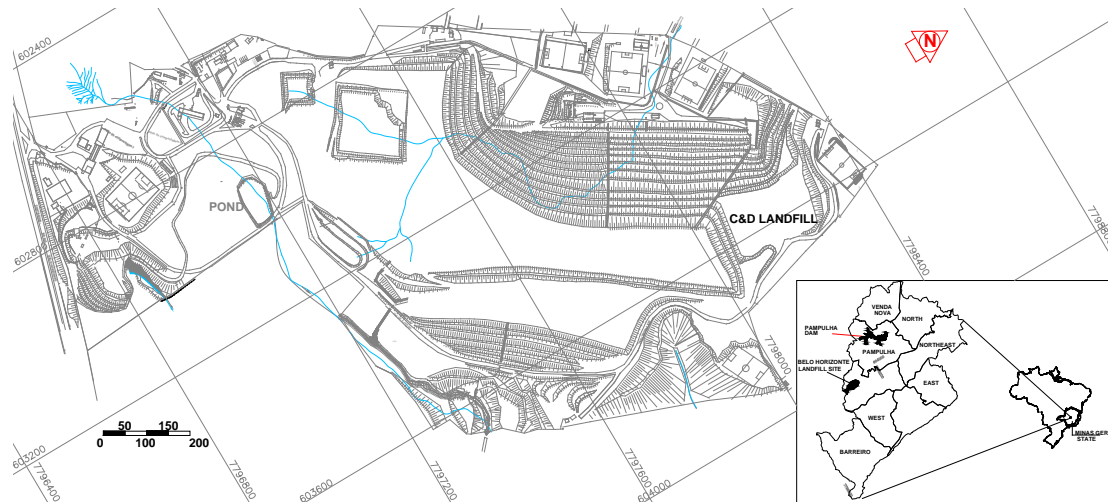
Aterro Sanitário de Belo Horizonte – Lay-out
